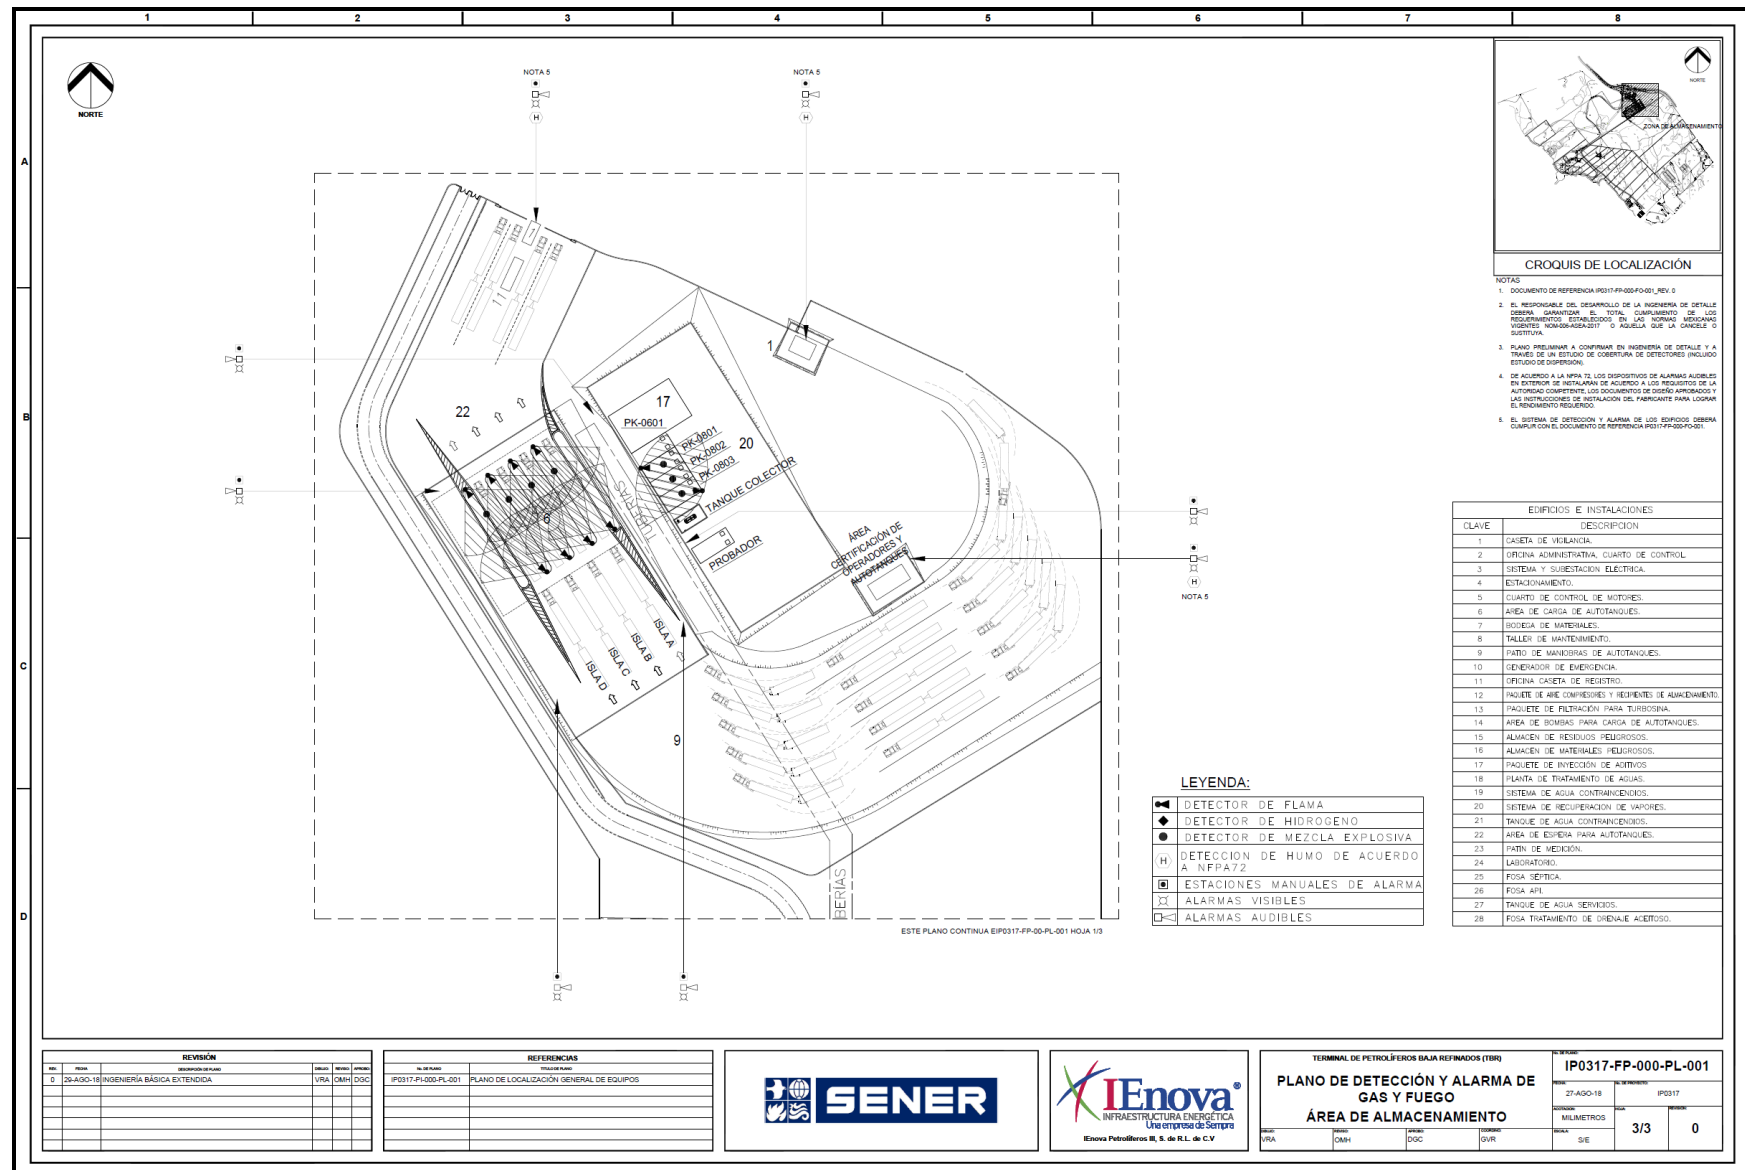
Plano de Detección y Alarma de Gas y Fuego - Área de Llenaderas.
